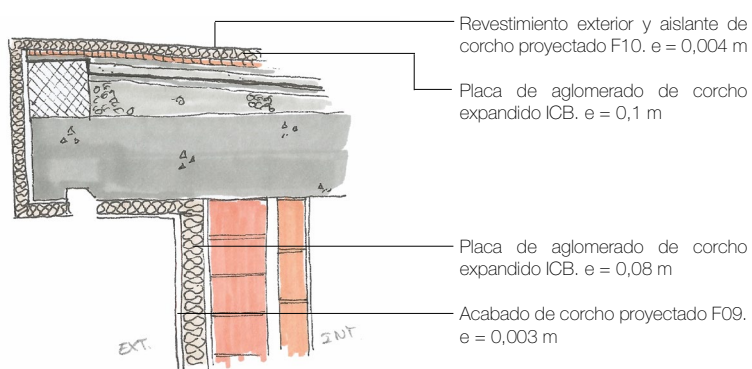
Detalle encuentro de fachada aislada con sistema SATE y cubierta plana aislada con corcho proyectado aplicado en su superficie (autoría propia).
